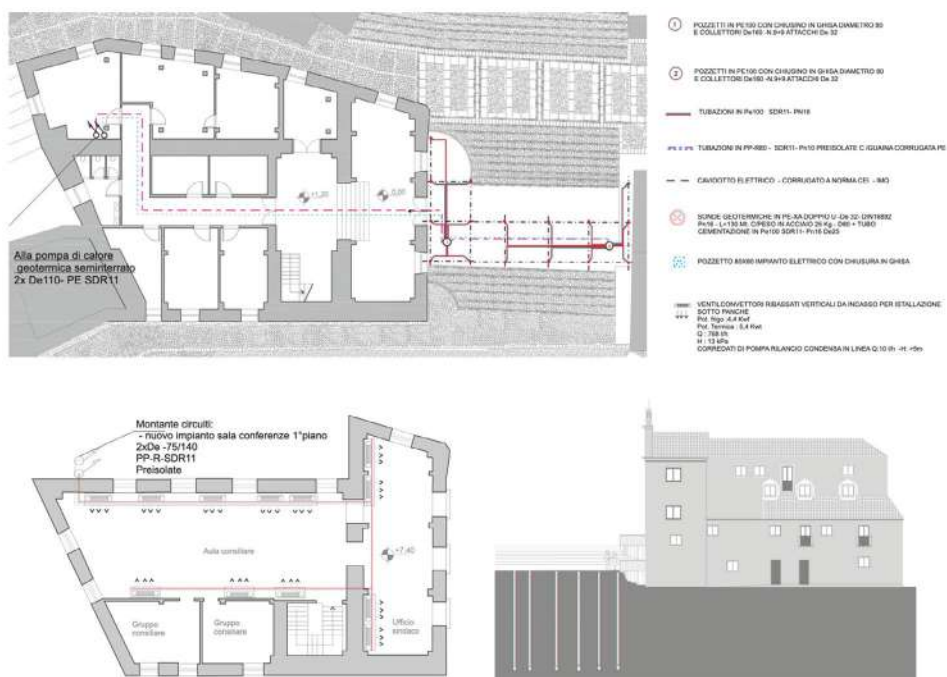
Esempio di installazione di un impianto geotermico nello storico edificio, sede del Palazzo Municipale di San Mauro Castelverde. Pianta del piano terra, pianta del piano primo e prospetto. (Immagine elaborate dall'Arch. Maria Rosaria Cimilluca.)
